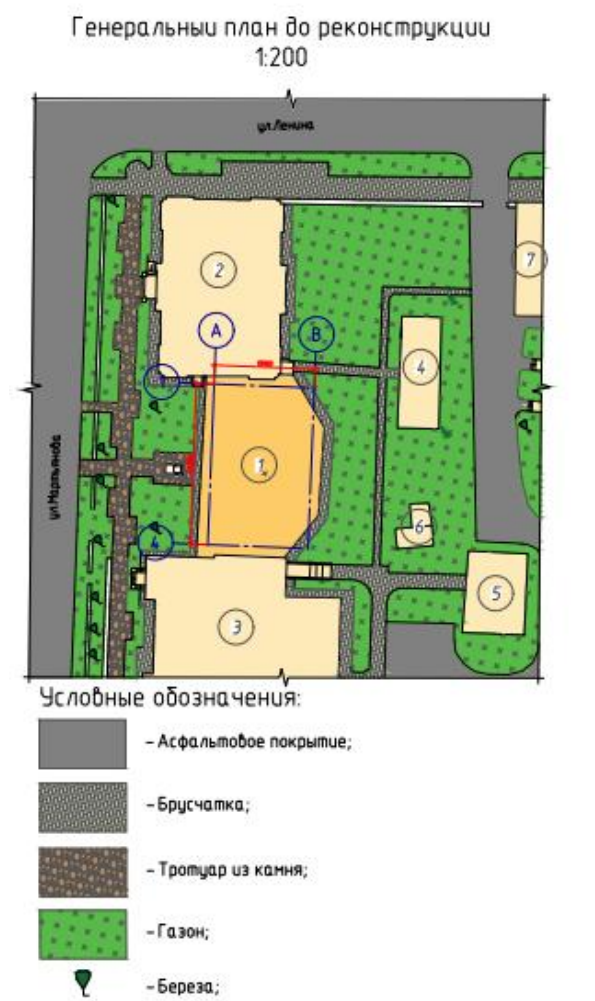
Генеральный план до реконструкции (1 – реконструируемый корпус; 2,3 – действующие корпуса музея; 4 – административный корпус; 5,6,7 – бытовые помещения)
